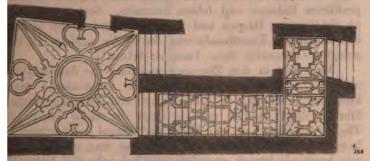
München. Residenz. Grundriss einer Treppe.
